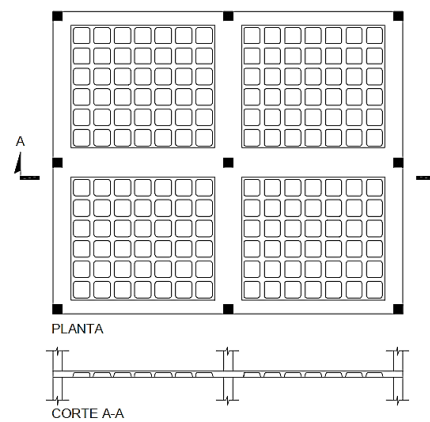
Laje nervurada com faixas protendidas (EMERICK, 2005).
